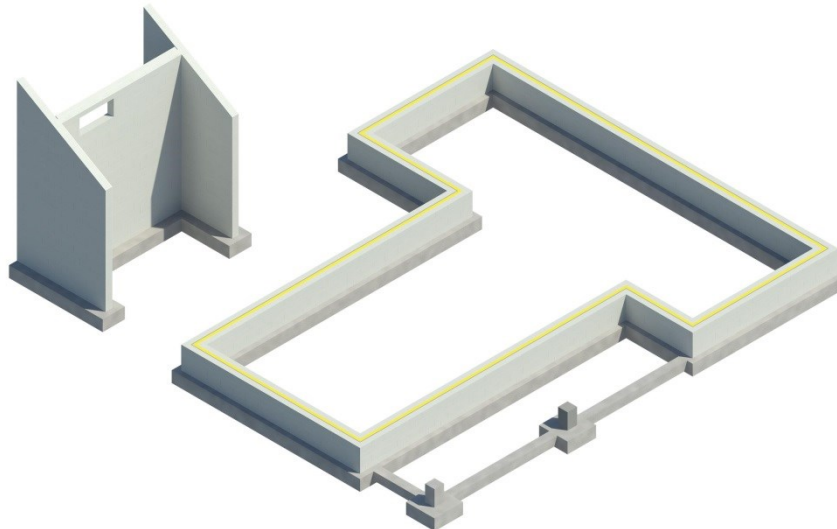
3D cimentació y, sobrecimentación. 2016. Creación propia.
